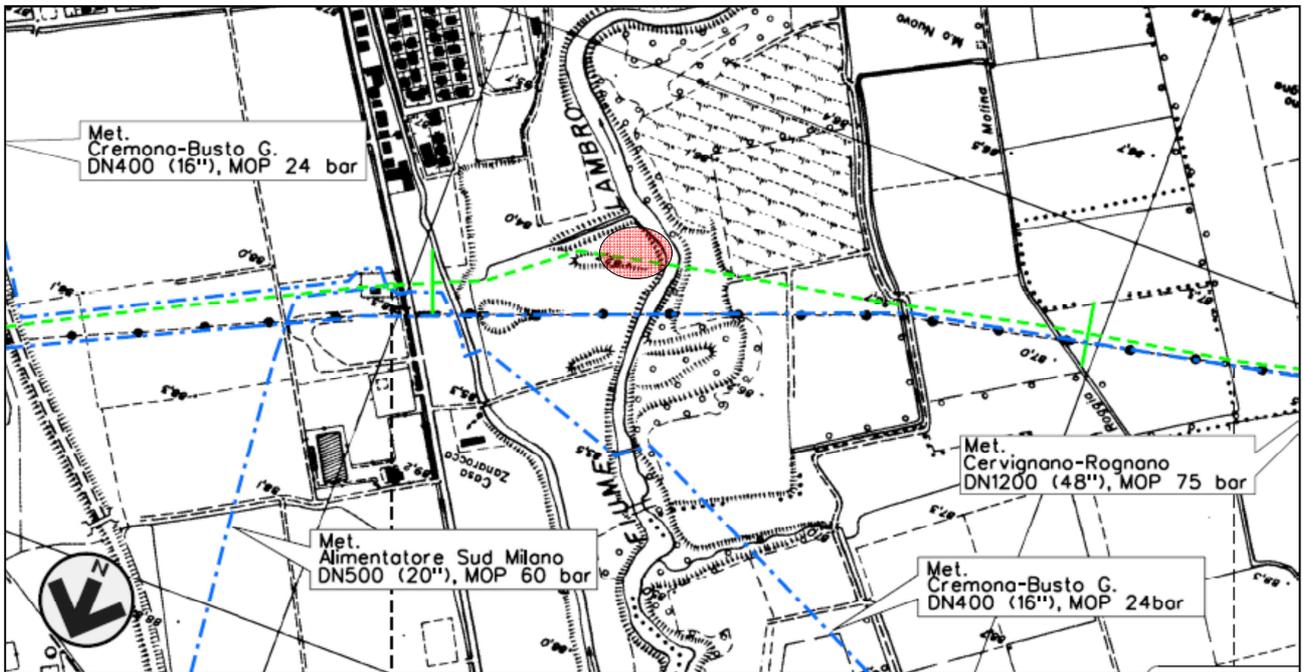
Localizzazione Area VER 01 LN su stralcio planimetria CTR scala 1:10.000
